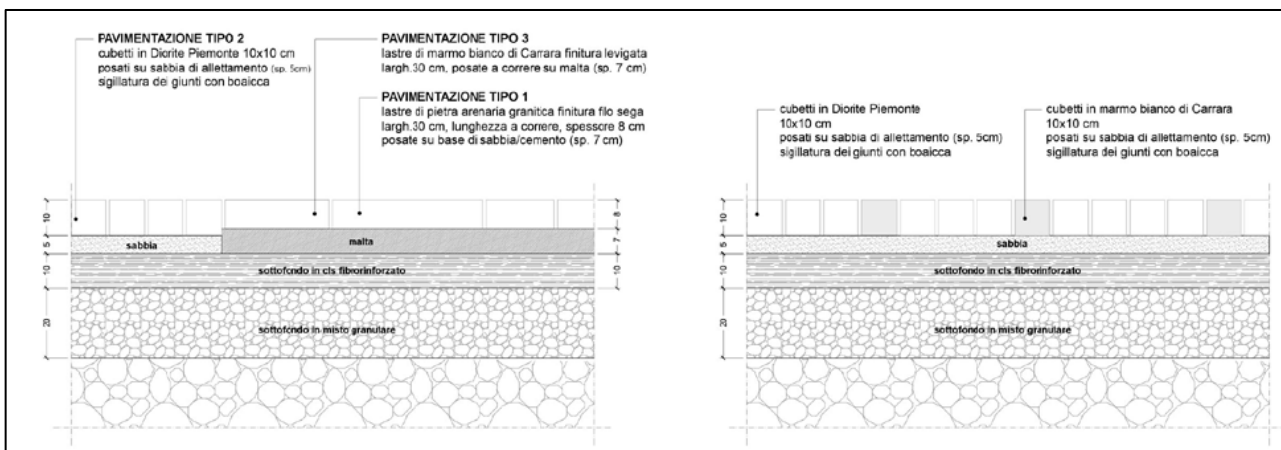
Dettaglio delle tipologie di pavimentazione previste a progetto (da committenza)
